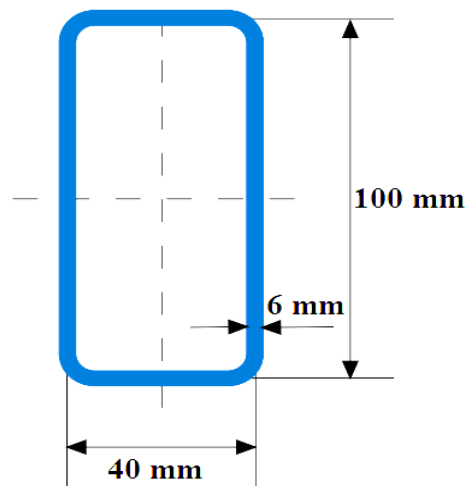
Parámetros dimensionales del perfil rectangular para la columna.
